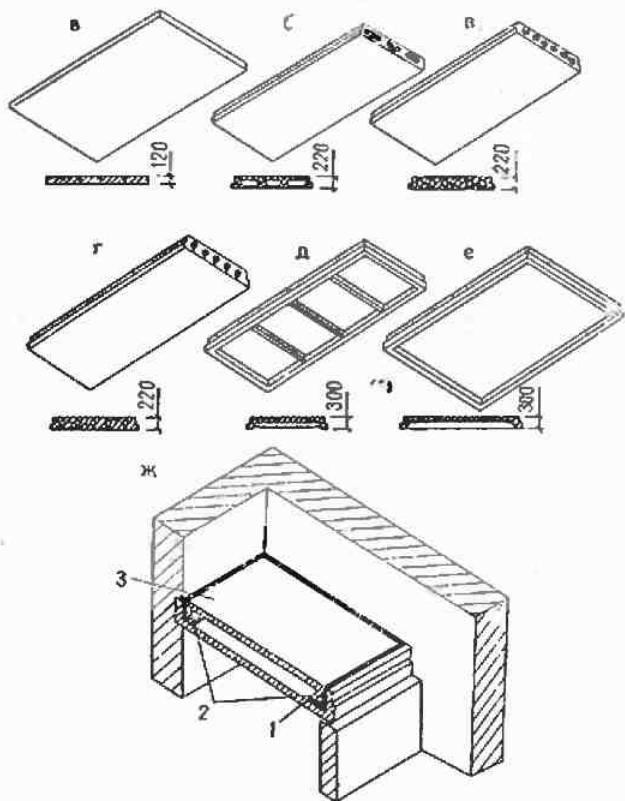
Основные типы сборных панелей и их сечения, применяемые в междуетажных перекрытиях. Раздельное перекрытие
